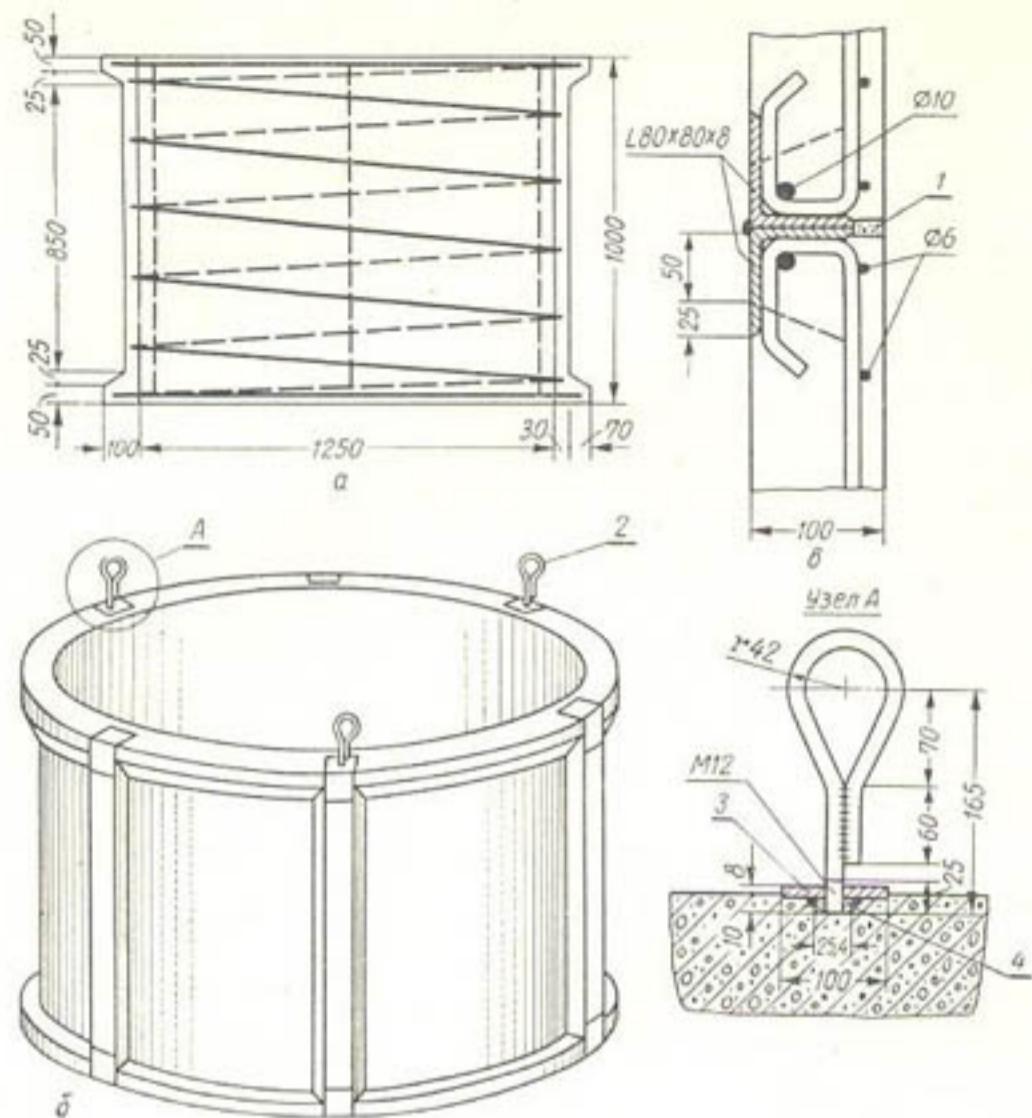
Железобетонные кольца для водонапорной башни емкостью 15 м<sup>3</sup> на опорах высотой 8 м:
